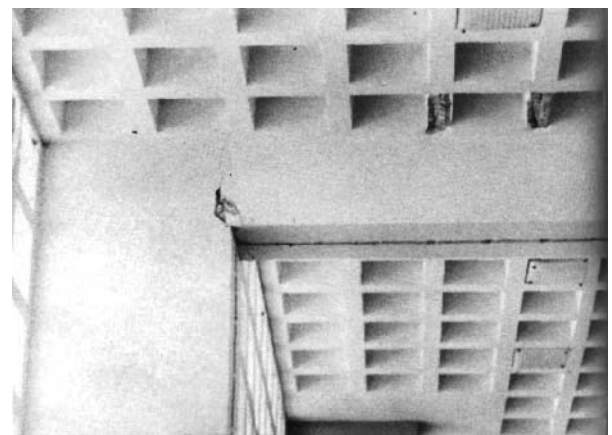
Fracture de la jointure poutre-colonne, intérieur de la façade du bâtiment des Services Municipaux
